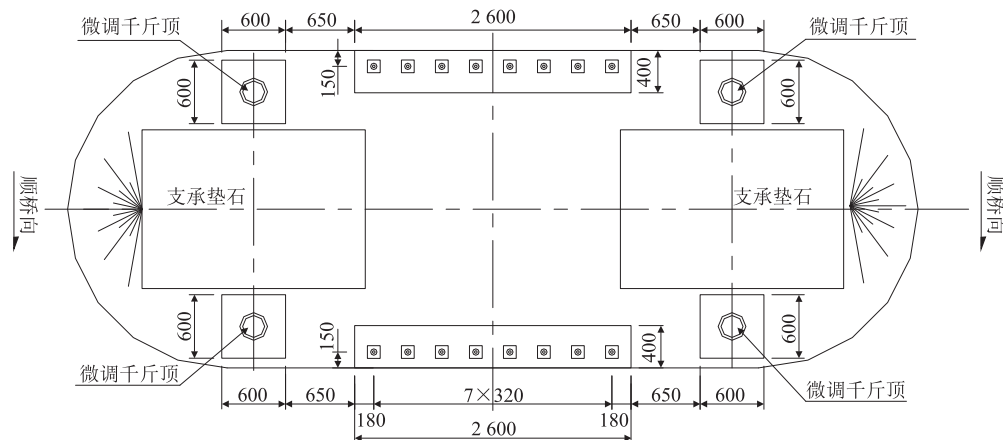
中墩墩梁临时固结构造及微调千斤顶平面布置图(cm)
